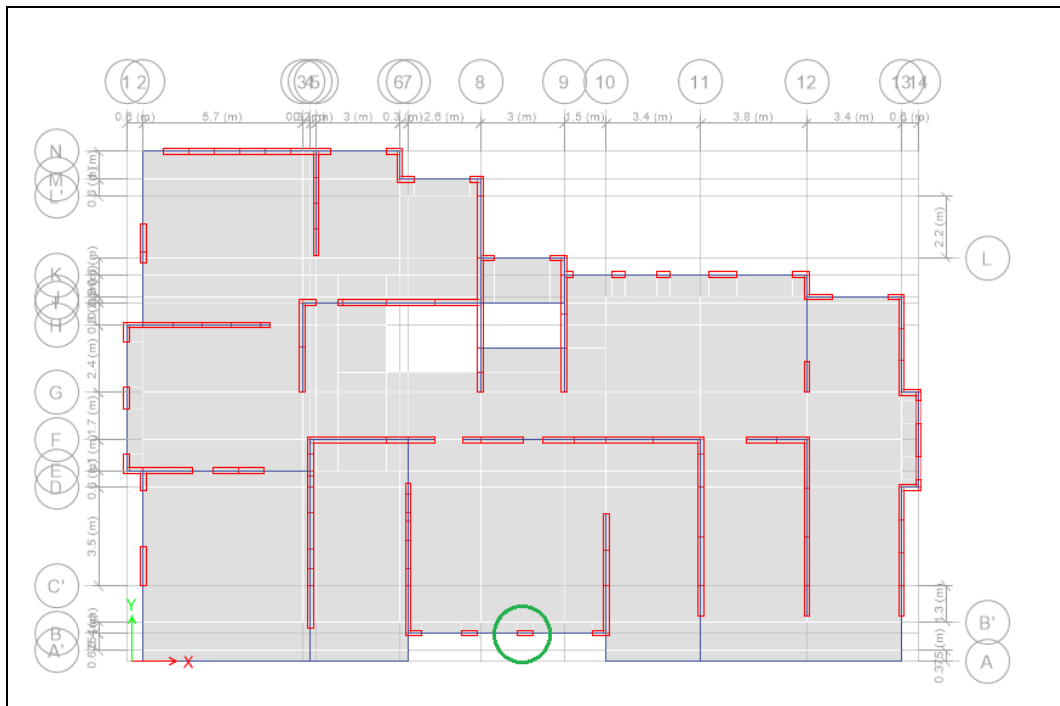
Edificio M8, planta piso 1, se indica el elemento M8-3 dañado
